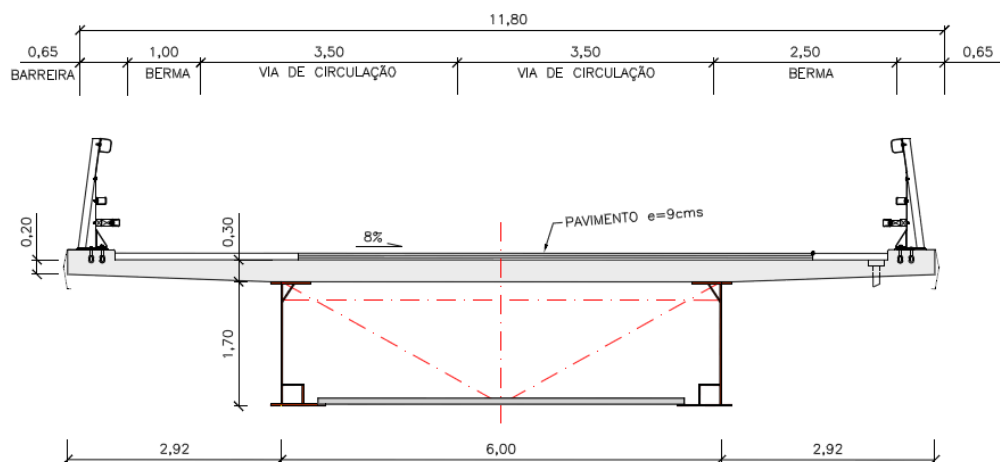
Secção transversal da Ponte Ute – Nueno em zona de centro de vão
